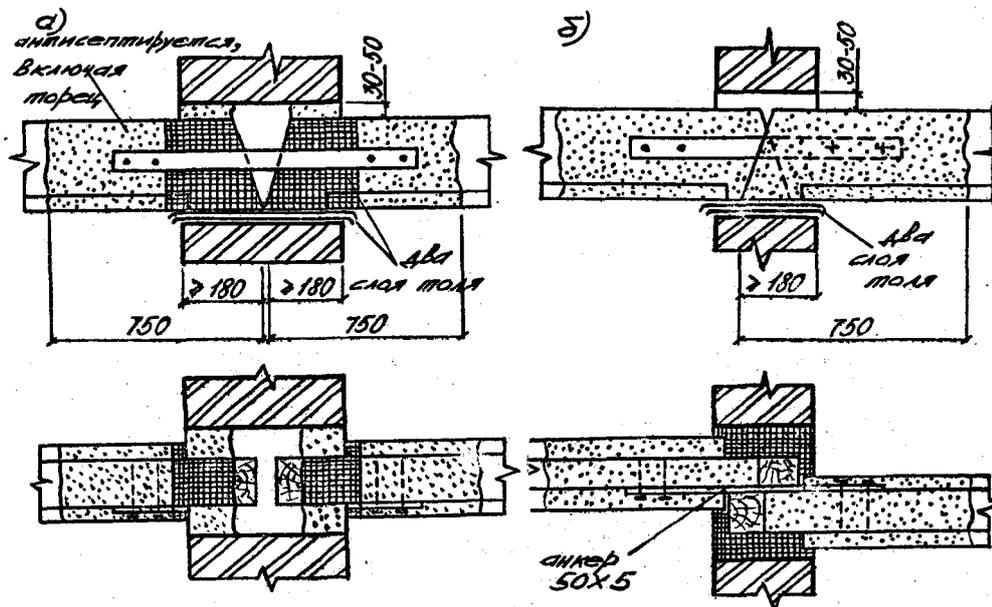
Опирание деревянных балок на внутренние стены:
